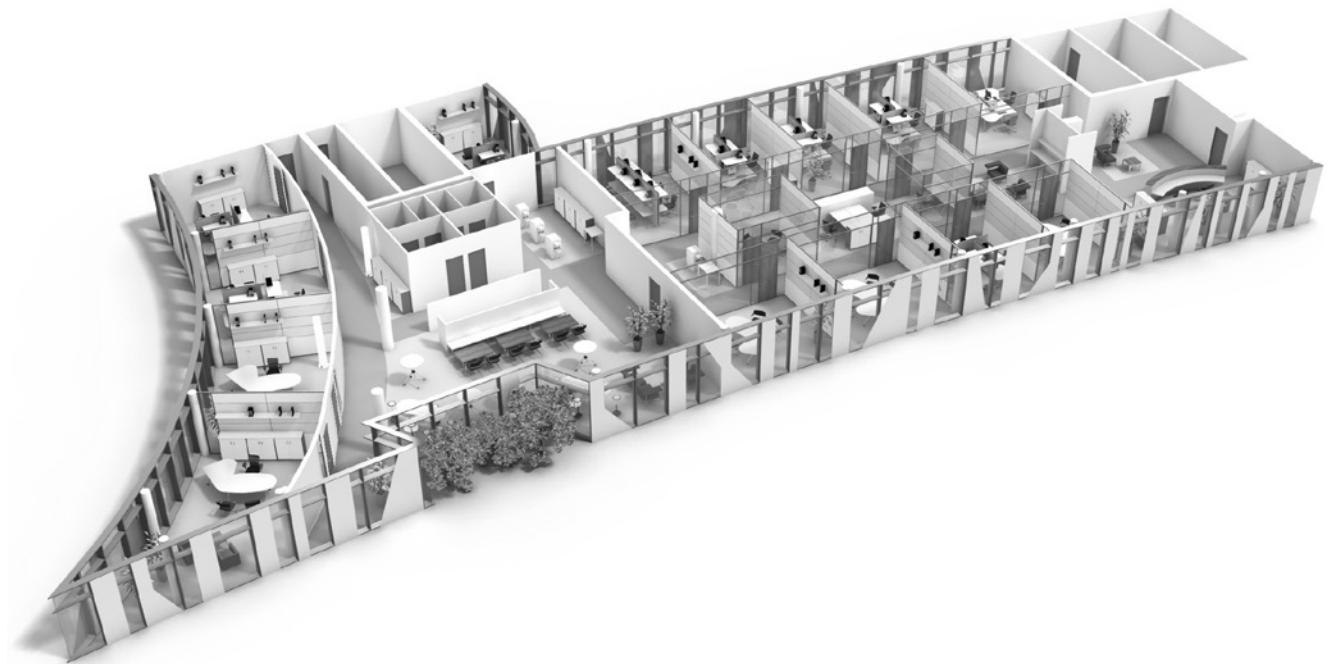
Perspektivischer Grundrissausschnitt Kö-Bogen, Düsseldorf
